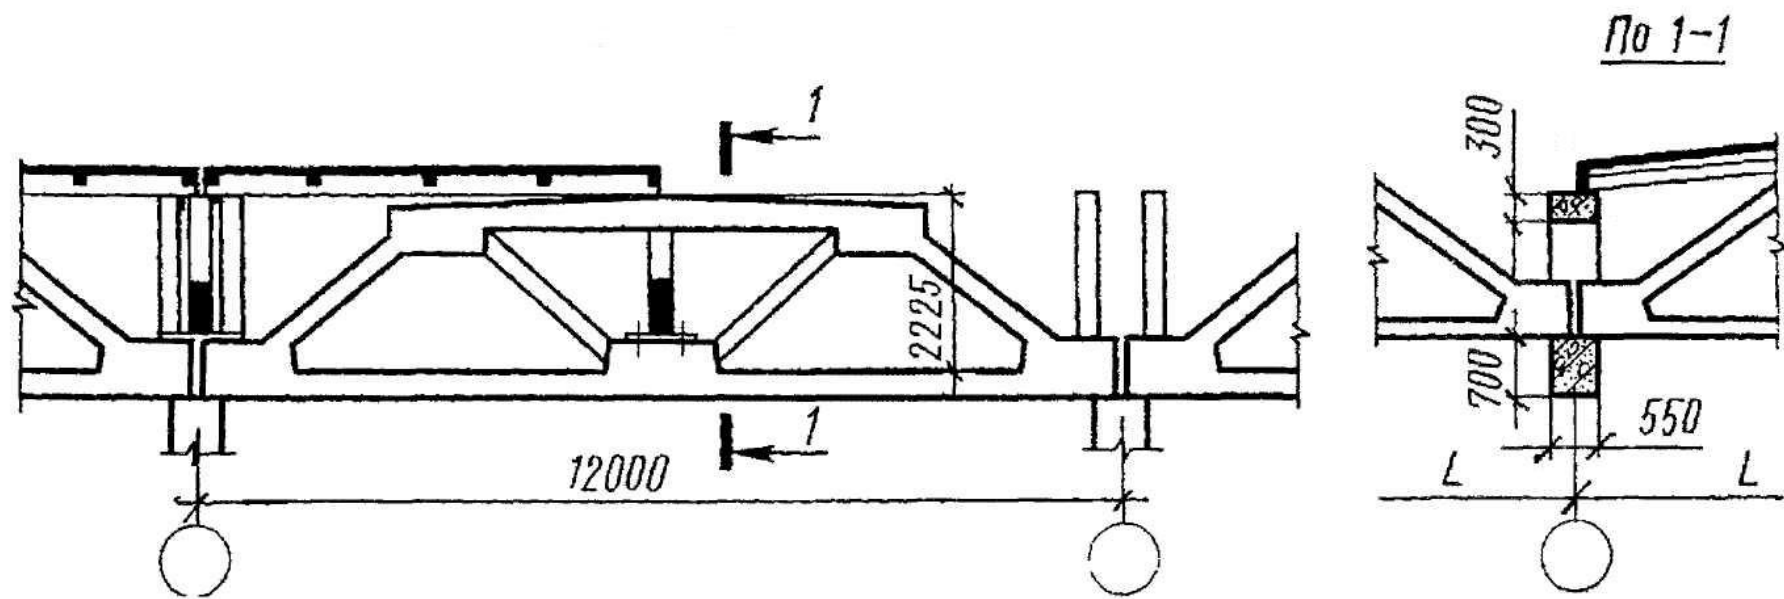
Железобетонная подстропильная ферма в установленном положении
